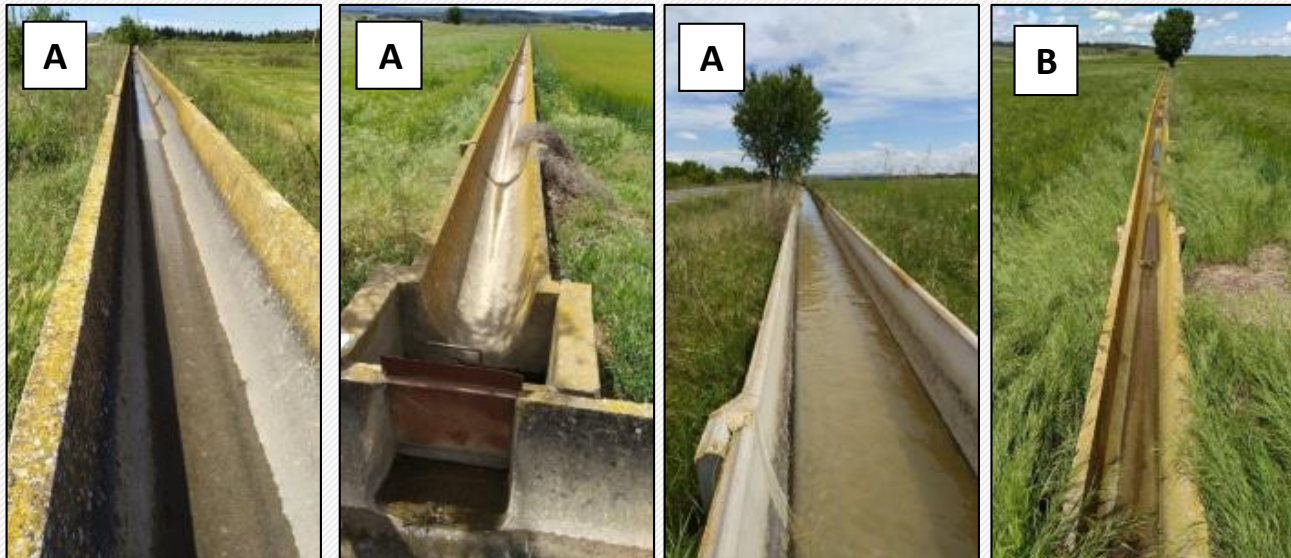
Canaletas Tipo A (Leyenda ■ ) y B (Leyenda ■ )
